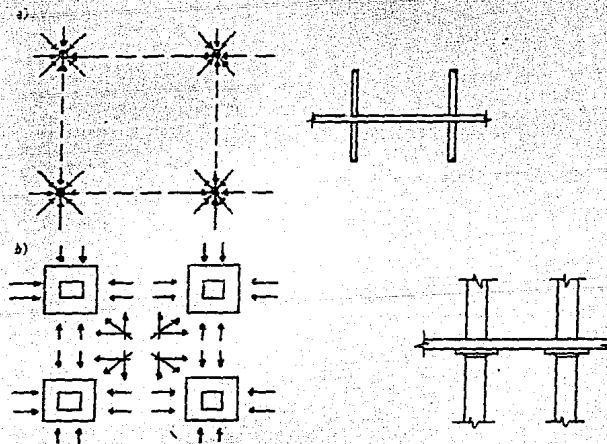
LOSA PLANA: a) PUNTOS DE SOPORTE (COLUMNAS)
